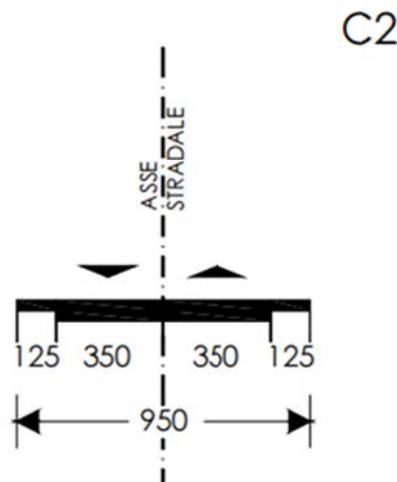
Sezione stradale tipo C2, D.M. 5.11.2001
